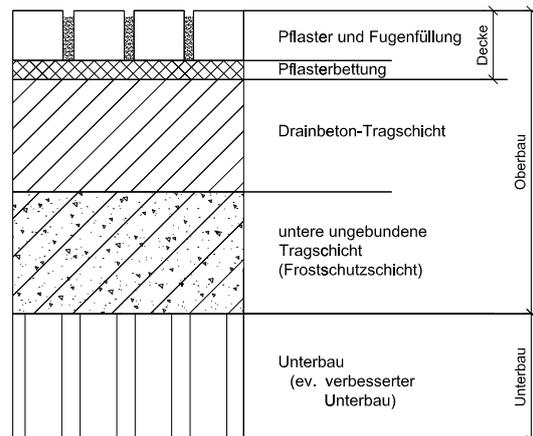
Aufbau einer Pflasterbefestigung mit Drainbeton-Tragschicht
